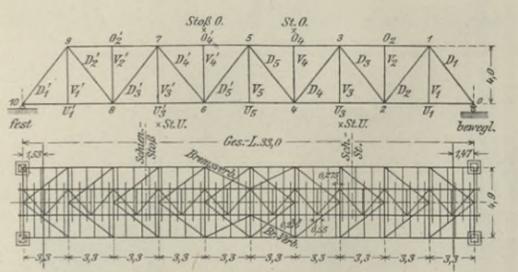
Netzwerk des Trägers und Grundriß der Brücke. (1:500)
